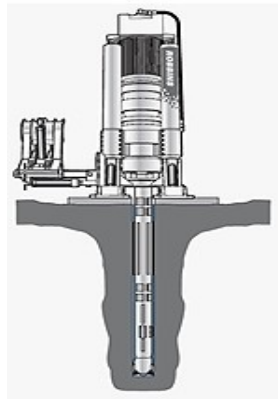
Representação esquemática da execução do furo piloto (Fonte: PTRE)
